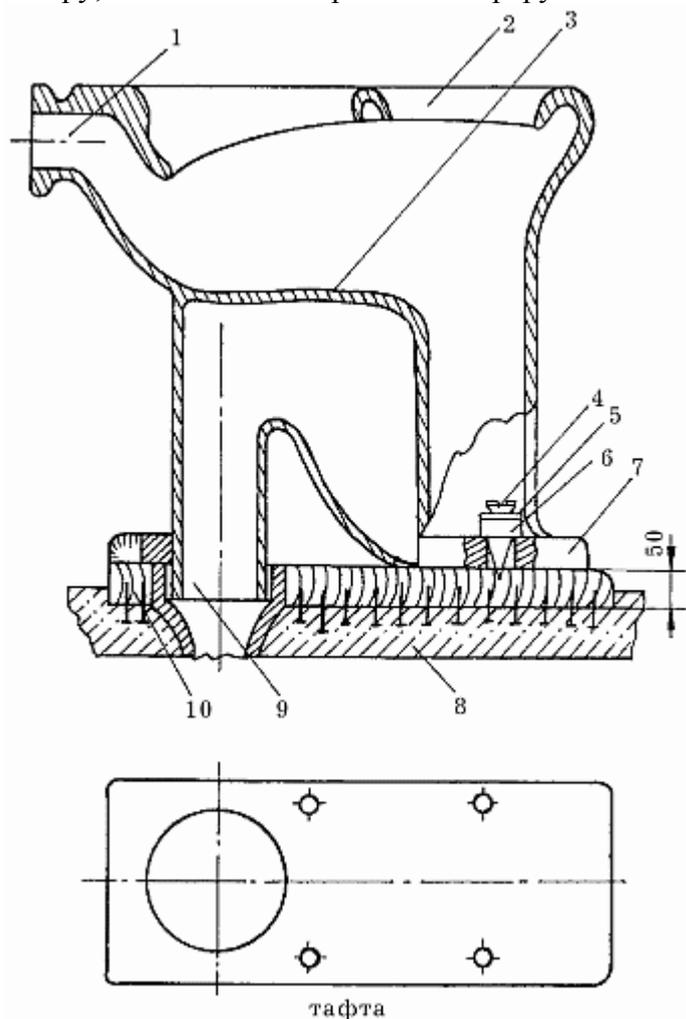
Установка унитаза с прямым выпуском на тафте: 1 – горловина; 2 – обод сиденья; 3 – тарельчатая чаша; 4 – шуруп; 5 – шайба; 6 – резиновая прокладка; 7 – прилив; 8 – цемент; 9 – выпуск; 10 – тафта с гвоздями.
